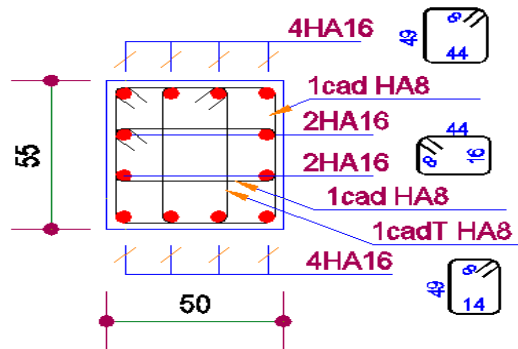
Schéma de ferrailage des poteaux du 6^{ème} et 7^{ème} étage
